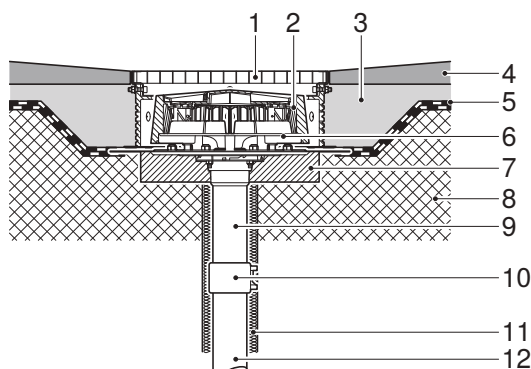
Montage dans toiture massive non isolée avec étanchéité de la toiture bitumineuse, carrossable
